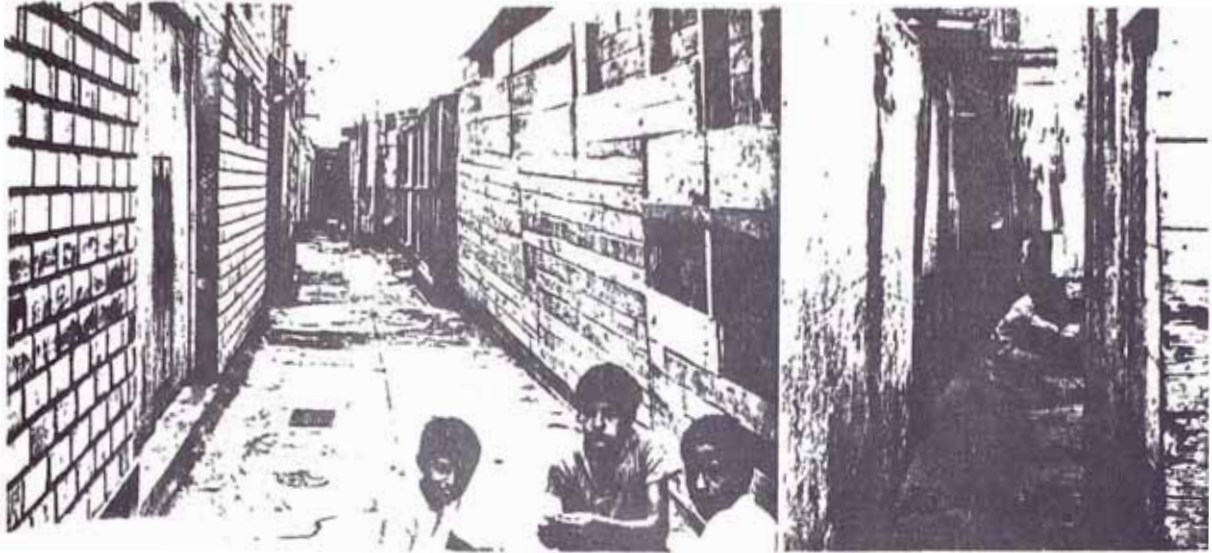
Construcción de madera en mal estado en la Cdra. 4 de Gamarra Chucuito (zona 3). Un tsunami de grado 2 ó 3 podría arrasarlo.
